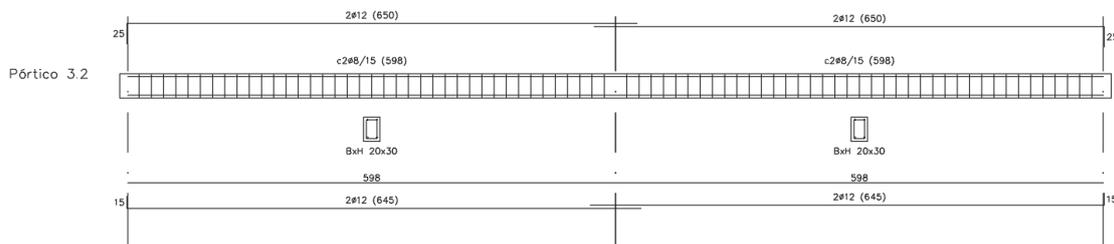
Propuesta de armado para la viga de 12m dividida en dos tramos
